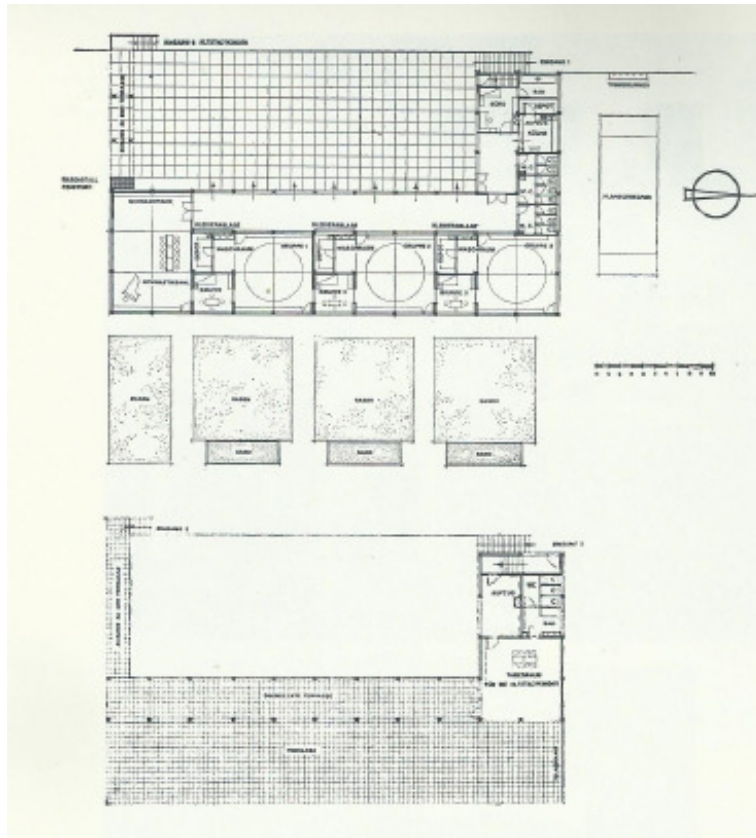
Kramer, F.: Erdgeschossgrundriss, 1928
